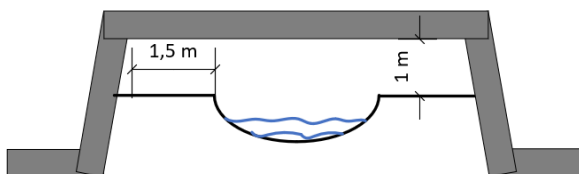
Underført faunapassage type A1U (tør), spunsbåret pladebro præfab. betonbjælkeelementer.
